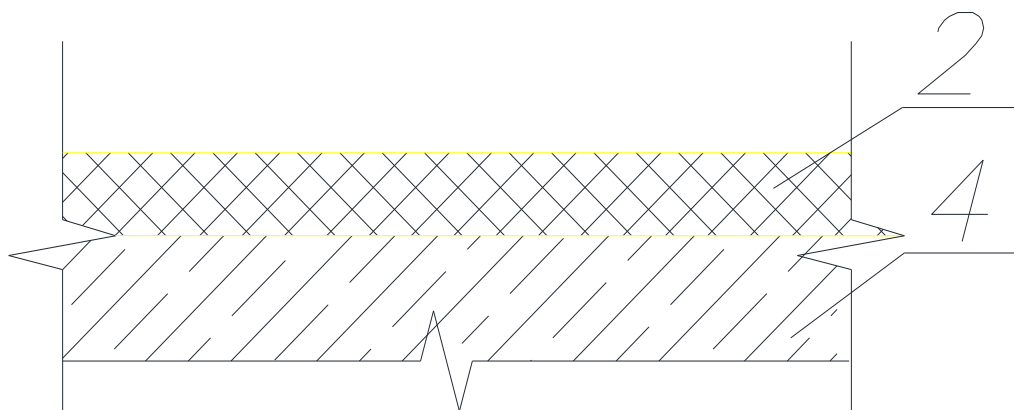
Конструкция покрытия над техническим этажом
